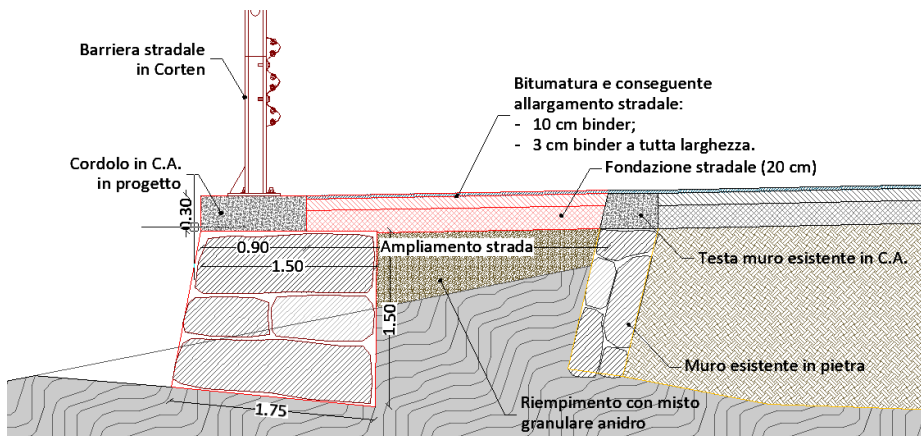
Sezione tratto stradale ampliato con sottomurazione
